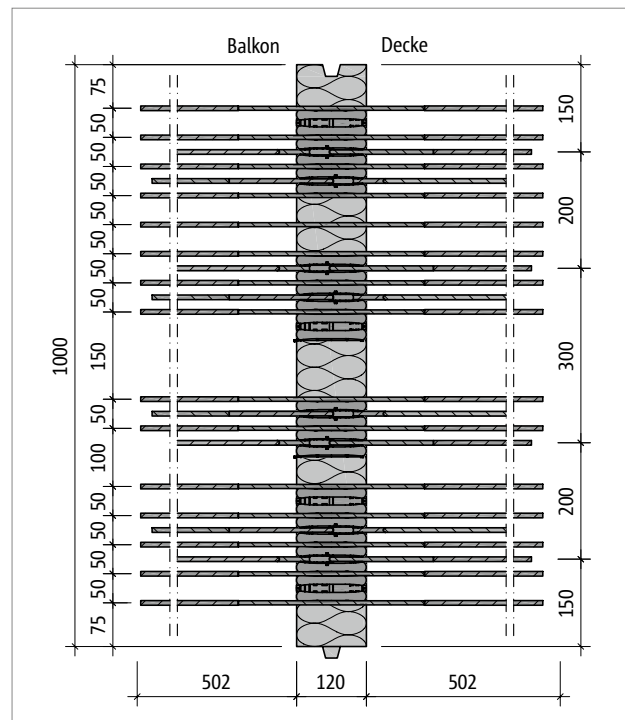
Schöck Isokorb® XT Typ KL-M5-VV1: Produktgrundriss
